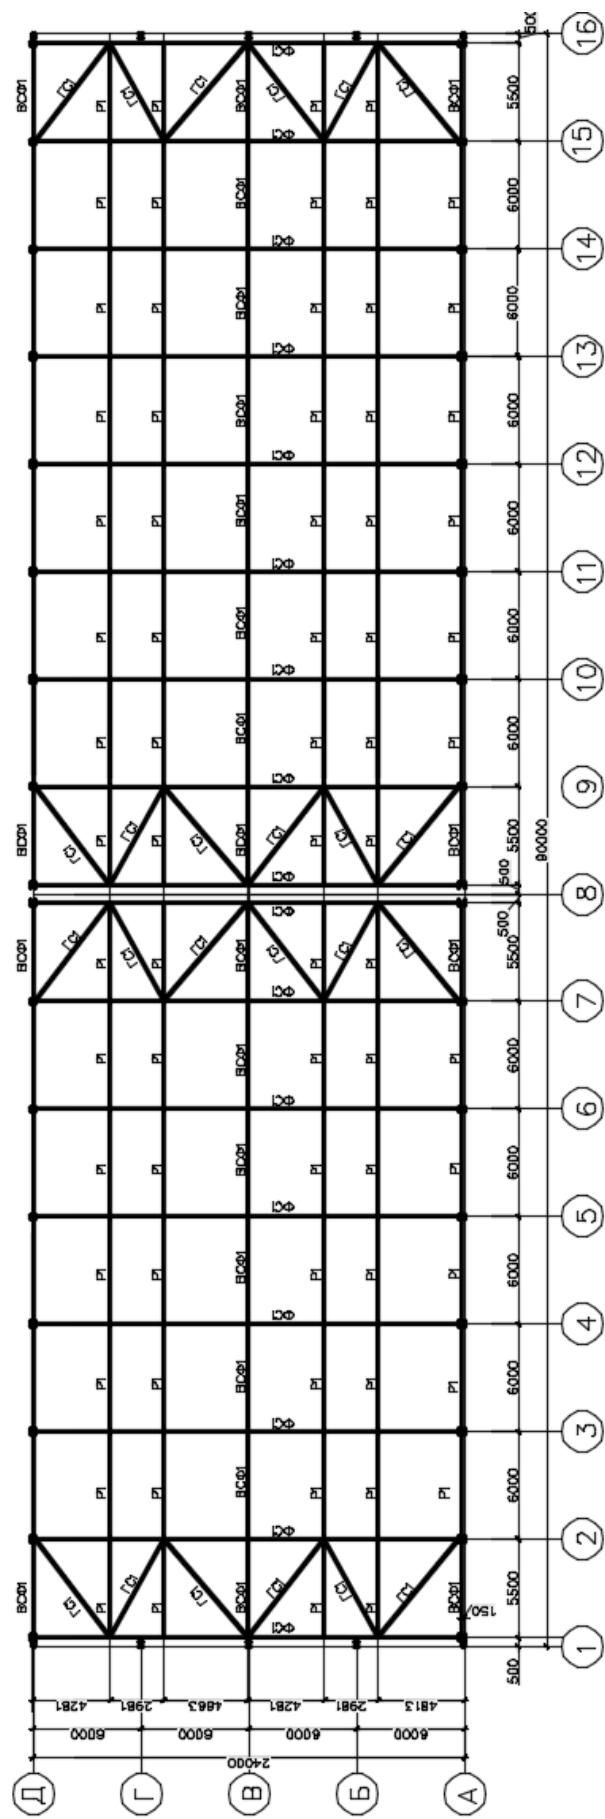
Схемы связей по нижним поясам стропильных ферм
